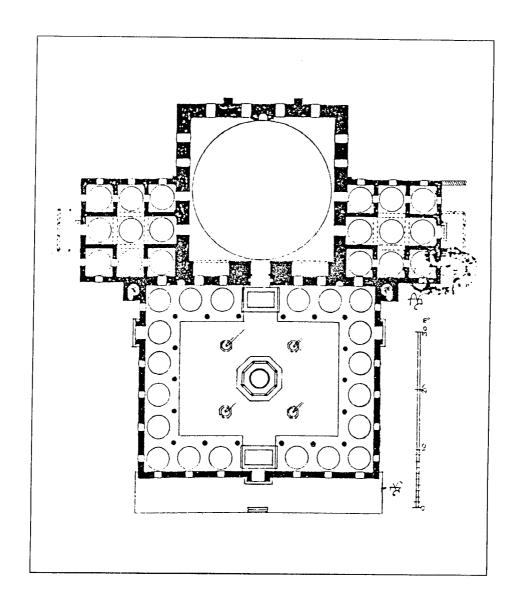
مسقط أفقي لمسجد الخنكار أو الحاكم في الباسان بالبانيا (عن : كيل) .
